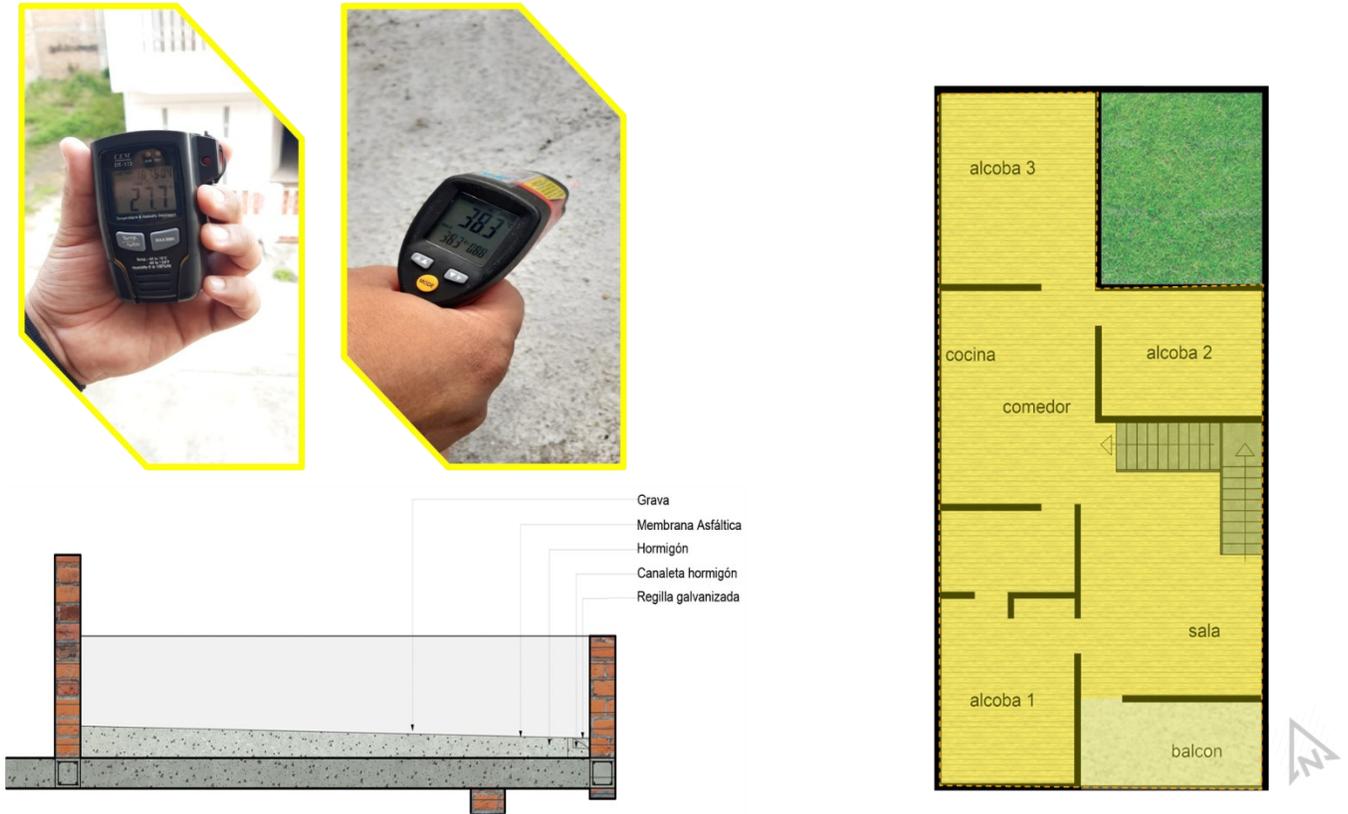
planimetría y fotos Fuente: propia Realizado: abril
